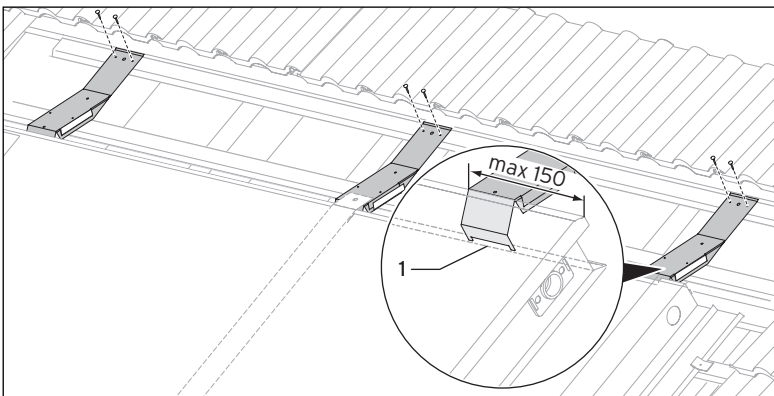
Установка опорных пластин (вертикальный коллектор)
